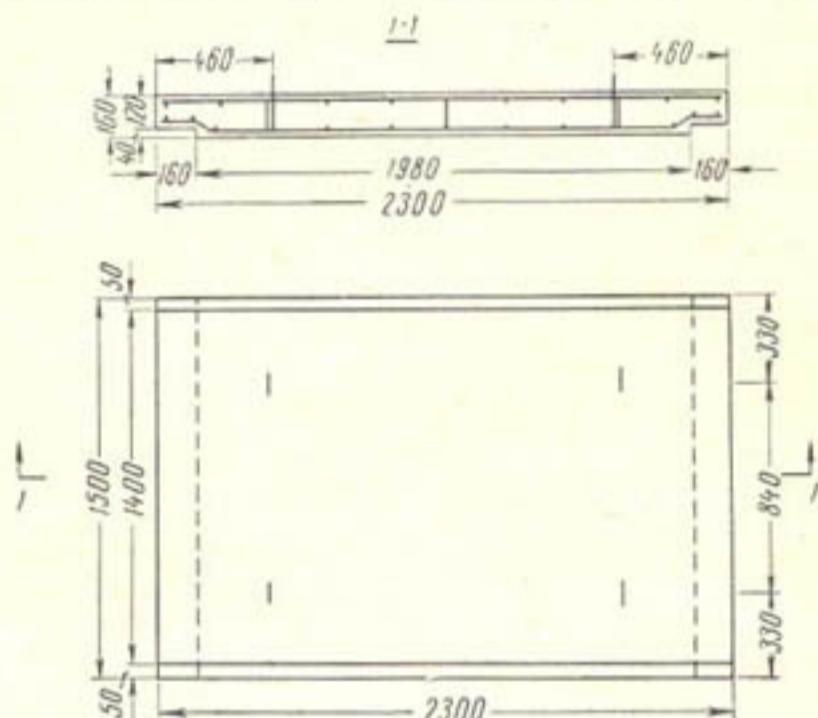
Плита перекрытия для переезда через открытый регулятор.
